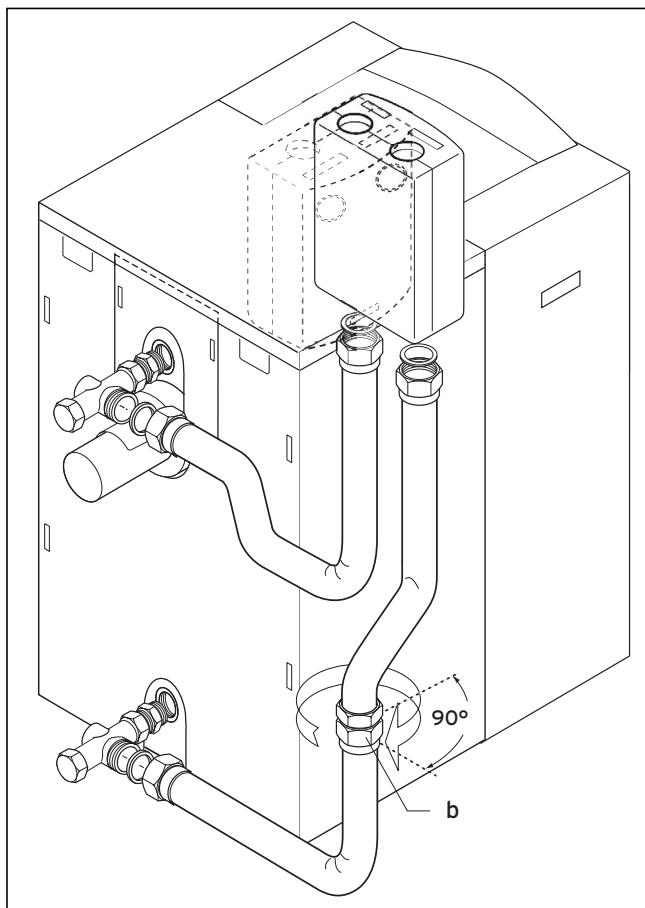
Anschluss an eine starre Kessel-Anschlussverrohrung
